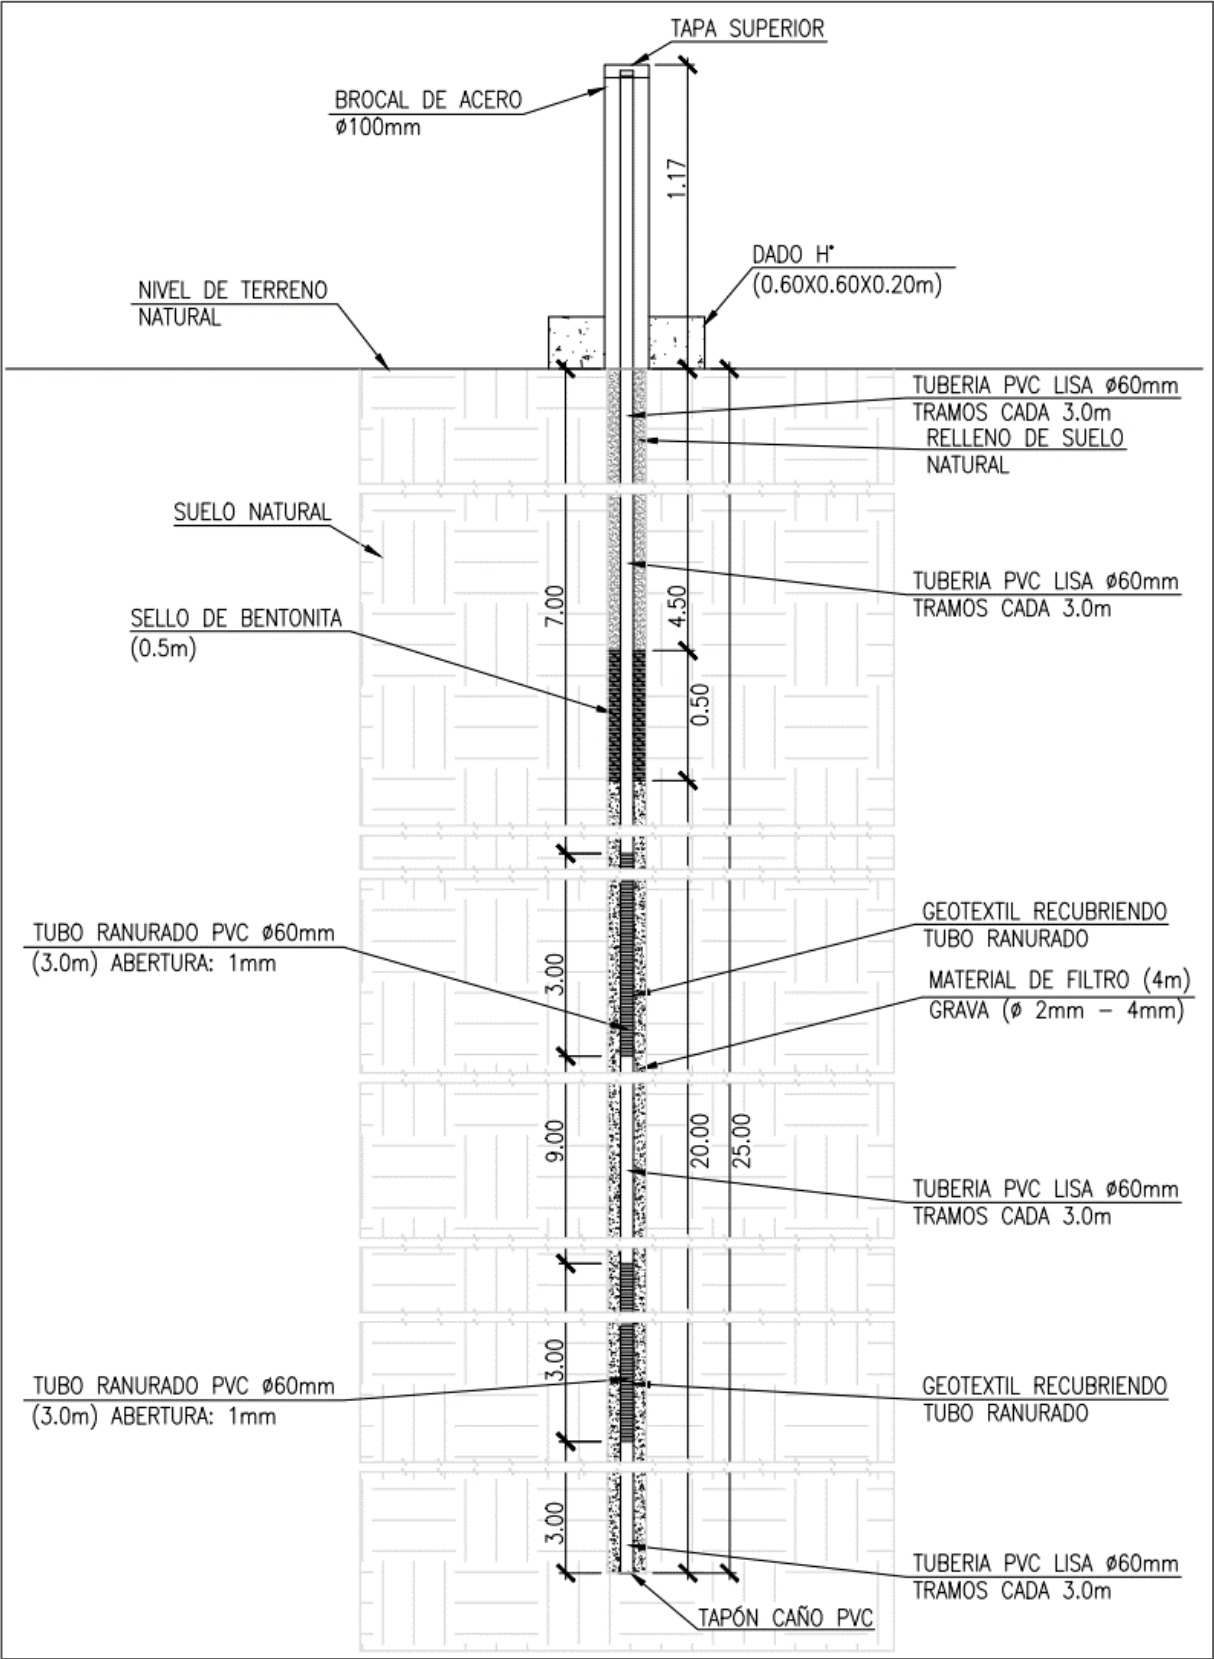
Esquema en detalle del perfil SRK-2023-BH01
